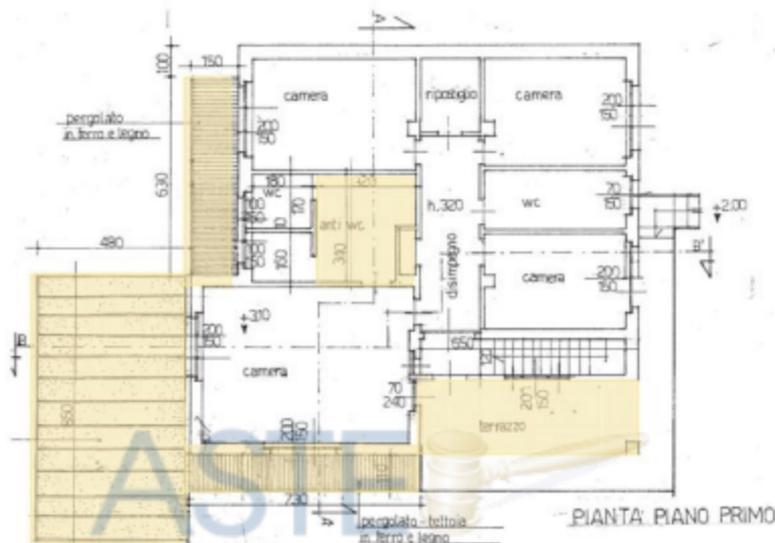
planimetria PIANO PRIMO autorizzata con C.E. n. 1248/1998
